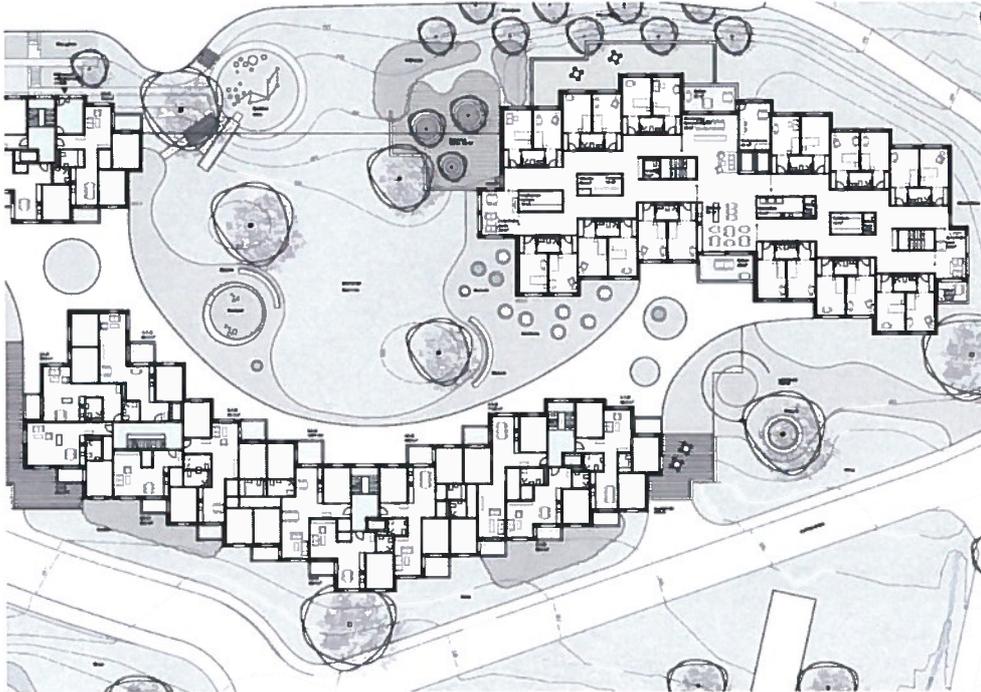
Ausschnitt Wohnungsgrundrisse
